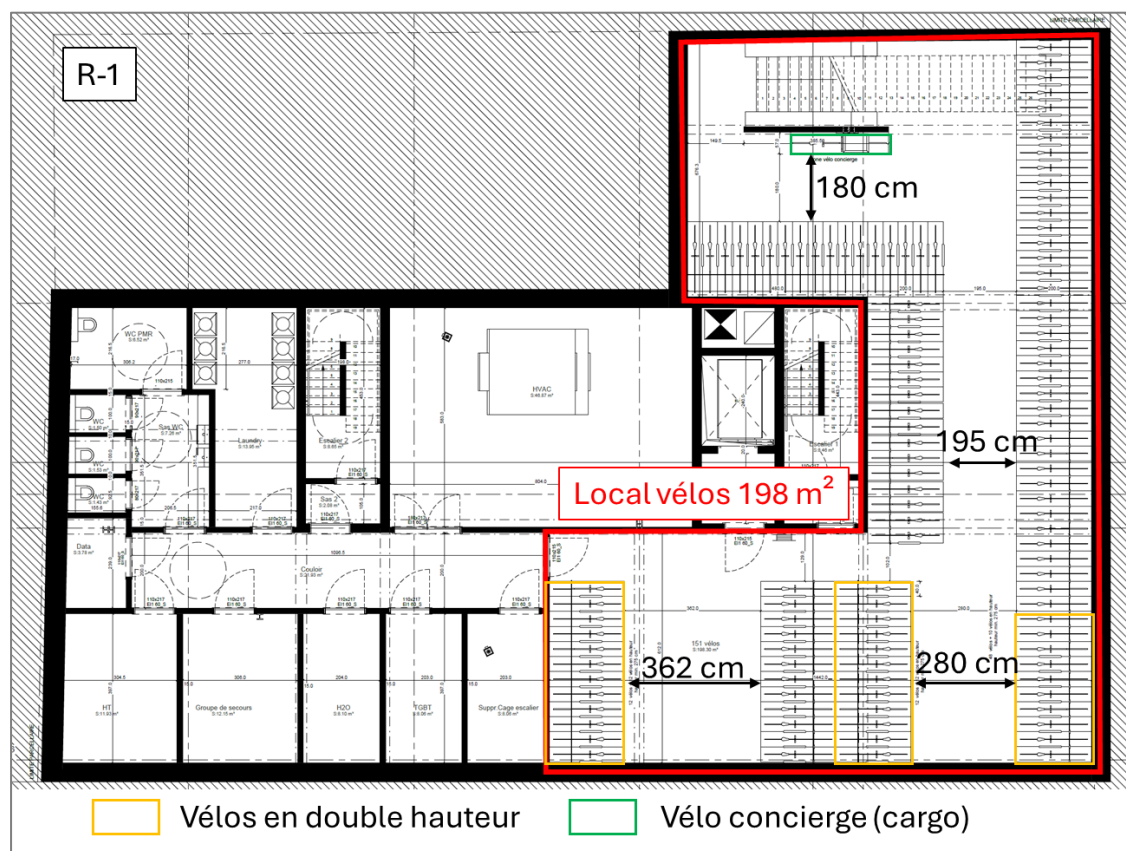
Localisation du local vélos au R-1 (source du fond de plan : B2Ai)
